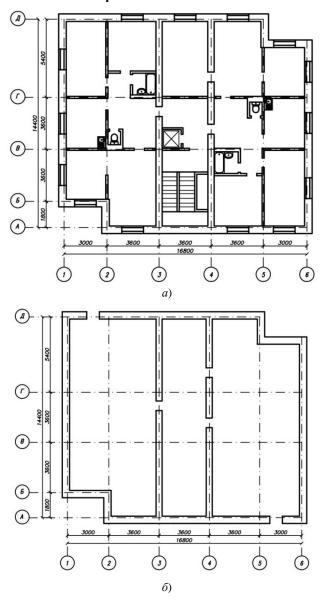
Вариант 1: a — план типового этажа; δ — план подвала
